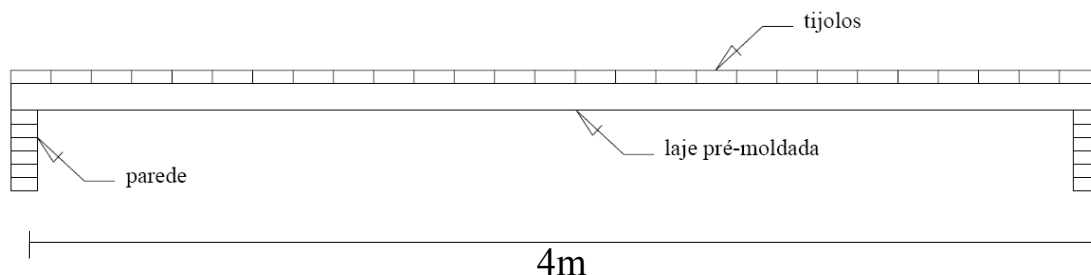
Seção longitudinal das lajes ensaiadas.
